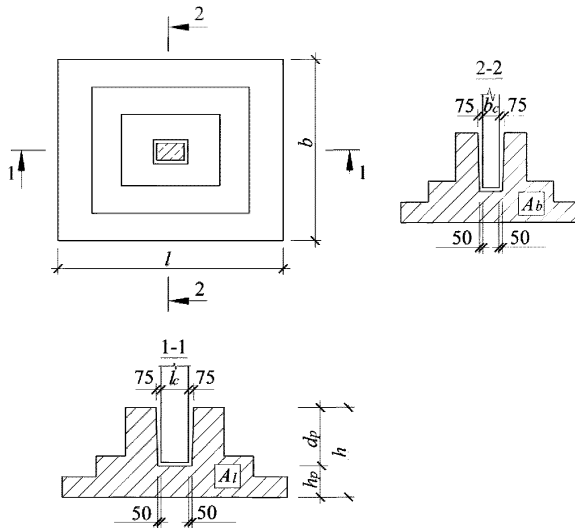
К расчету фундамента стаканного типа на раскалывание
